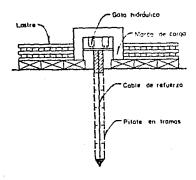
A.5.-PILOTE HINCADO A PRESION.
